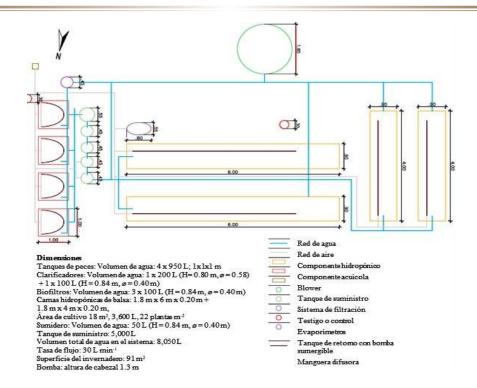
Diseño y dimensiones del sistema acuapónico instalado. Figure 1. Design and dimensions of the installed aquaponic system.
